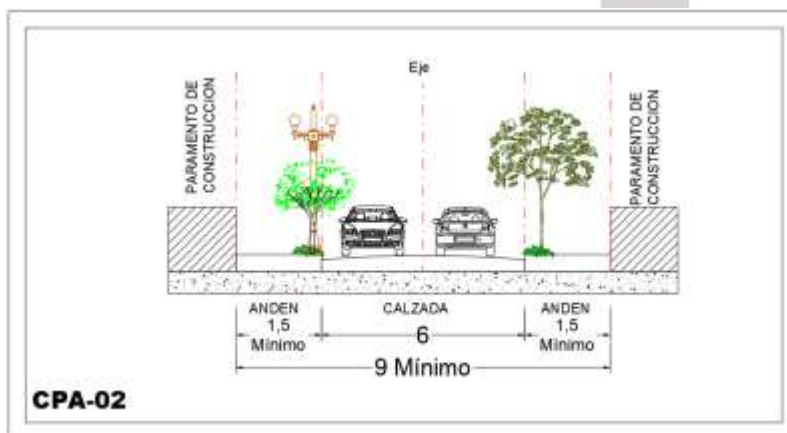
Perfil vial CPA-02 secundario para el centro Poblado La Aguadita.
